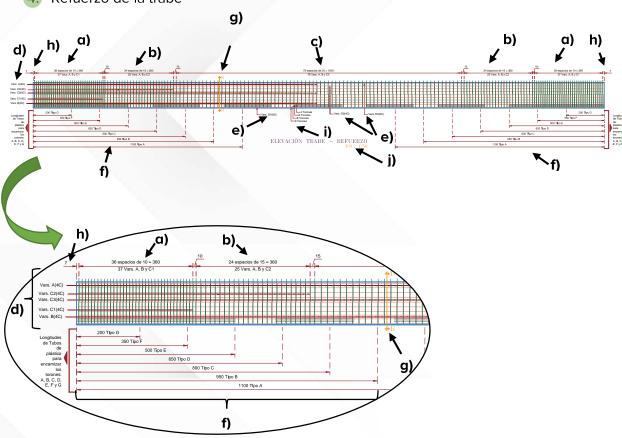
Ejemplo refuerzo de la trabe (elemento 4)
